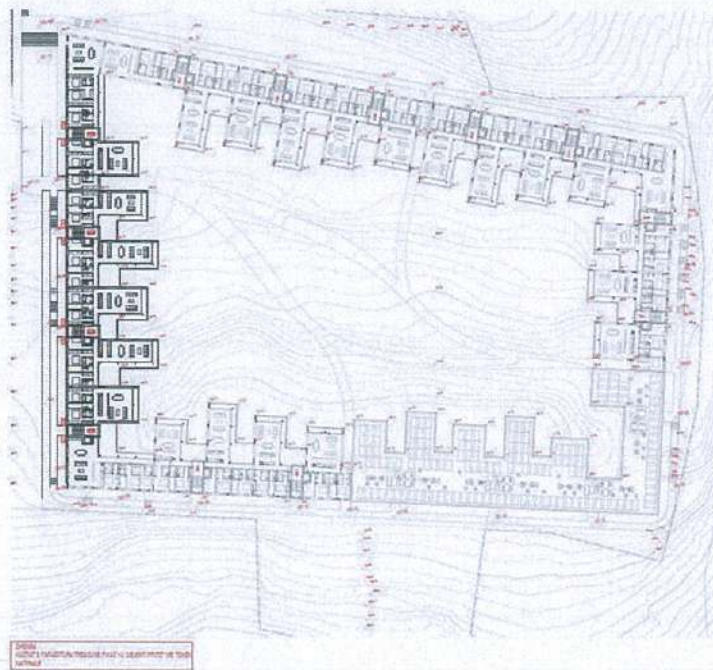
Planimetria e tarraces ne Kuoten + 208.45
